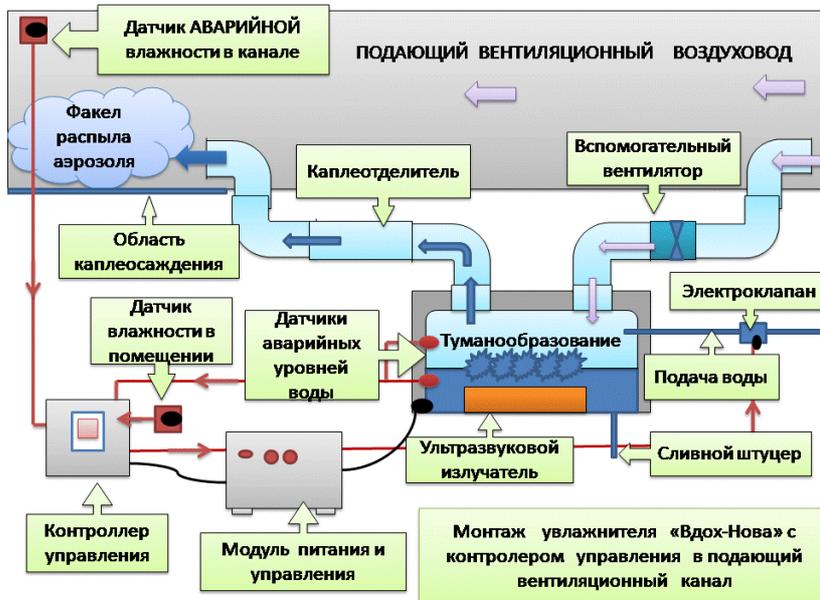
Пример Монтажа канального увлажнителя Вдох-Нова 6000 в вентиляционный канал жилого помещения (квартира в строительном состоянии площади 75 кв.м.) .
